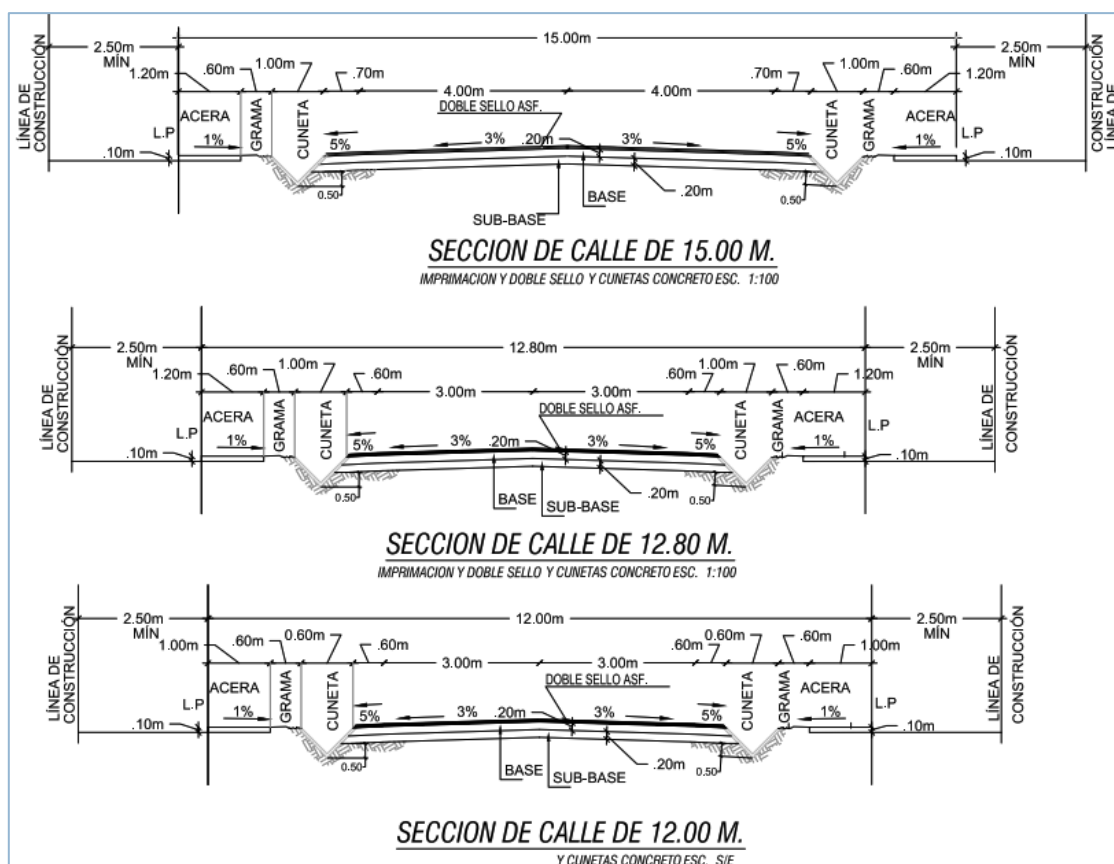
Sección de las calles del proyecto. Fuente: Planos de anteproyecto.
